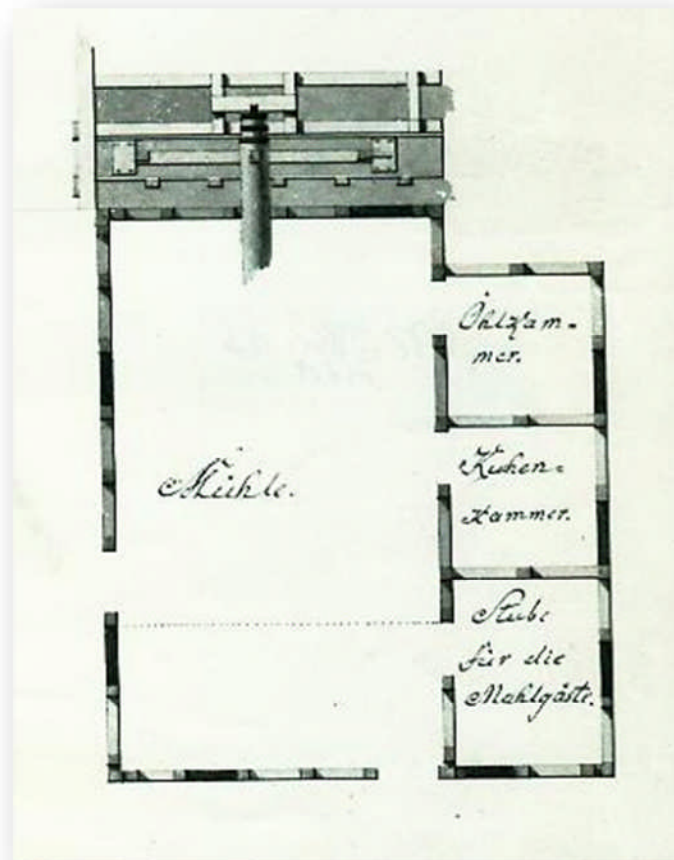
Grundriss der beim Schloss Brake gelegenen Ölmühle. Jahr 1806. (StADt L 92 C Tit.1 Nr.13)
